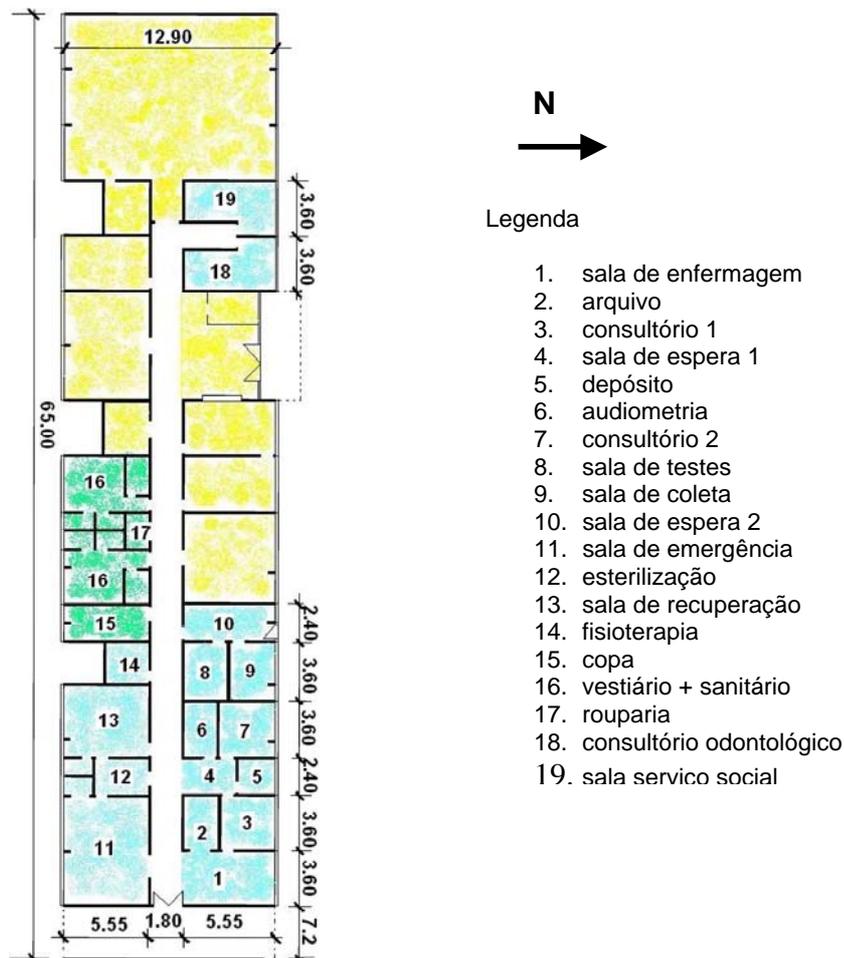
Planta baixa da edificação com a localização dos ambientes do serviço médico
